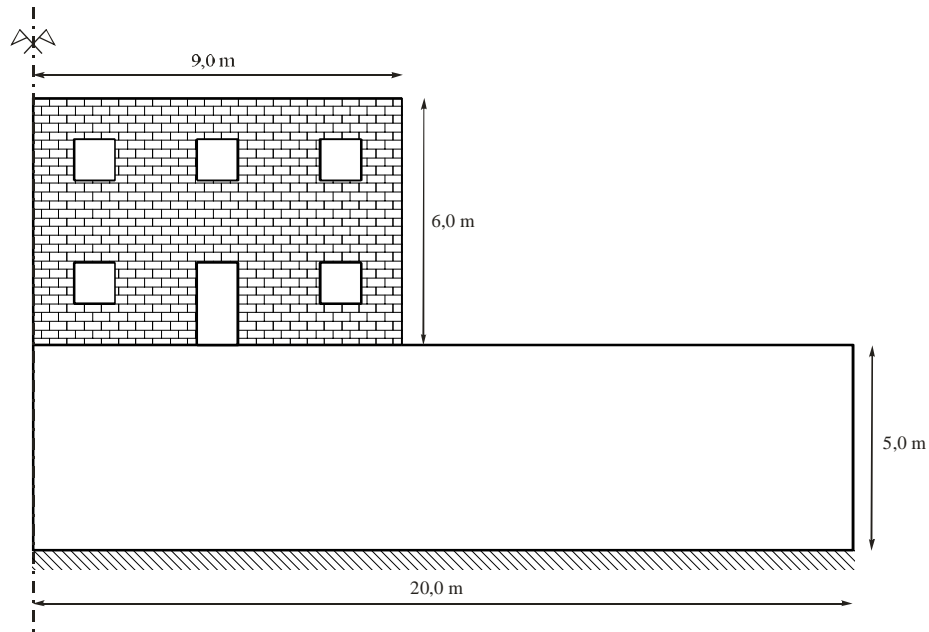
Geometria e dimensões do modelo da fachada de edifício e fundação.
